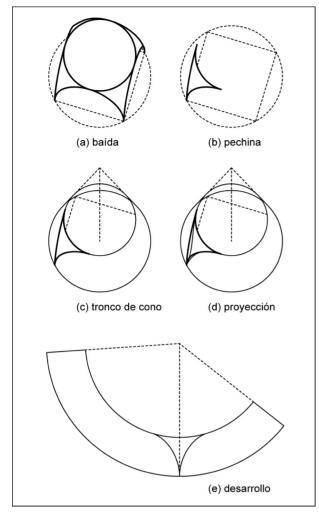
Obtención de la plantilla de una pechina mediante CAD.
